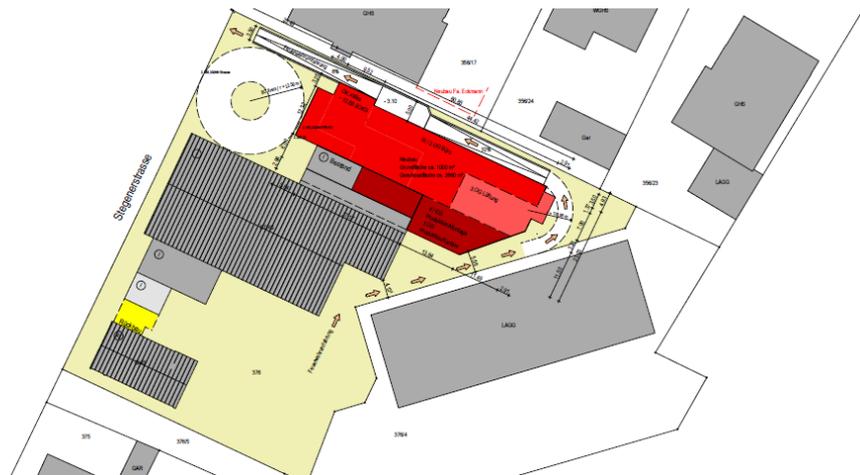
Planung gemäß Bauantrag zum geplanten Neubau der Firma Walcher (Ausschnitt) (Quelle: Gemeinde Kirchzarten).
